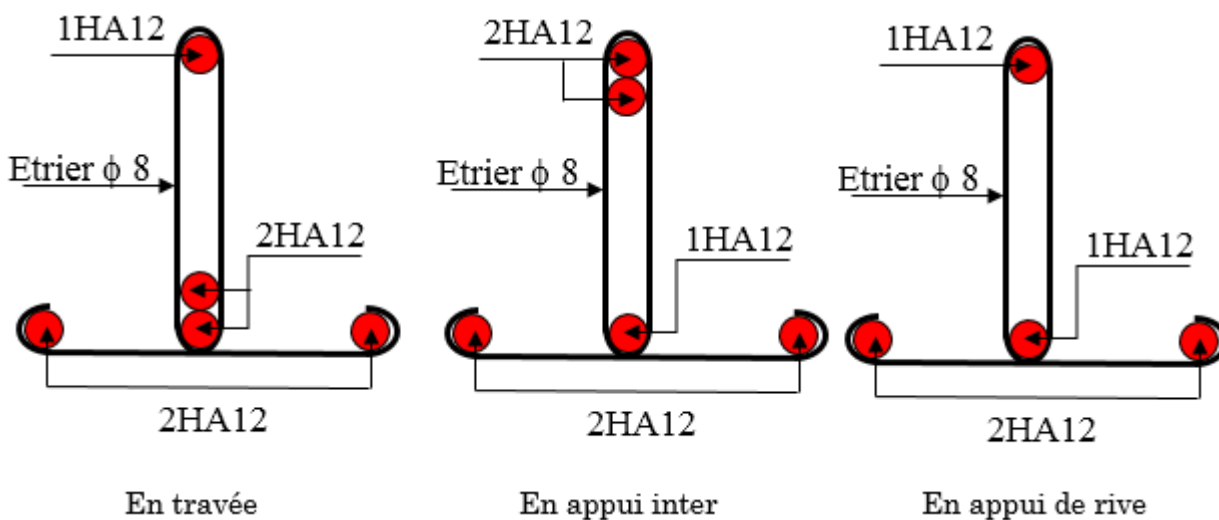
Schéma de ferrailage des poutrelles Terrasse inaccessible.
